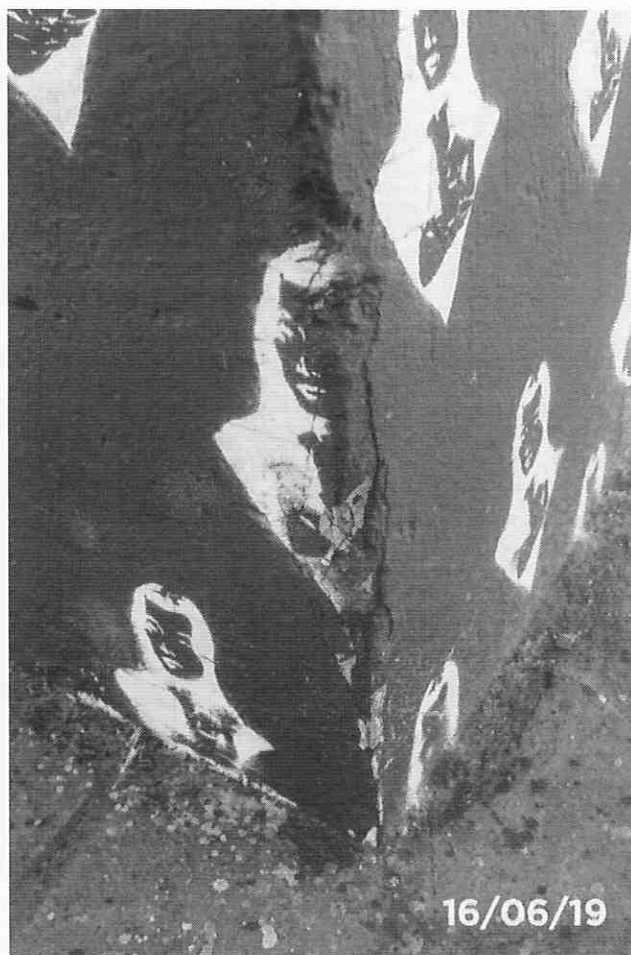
Detalhe segregação do concreto, trincas, deslocamento do concreto do pilar, pontos aparentes de bolor, devido a infiltração de água no concreto
